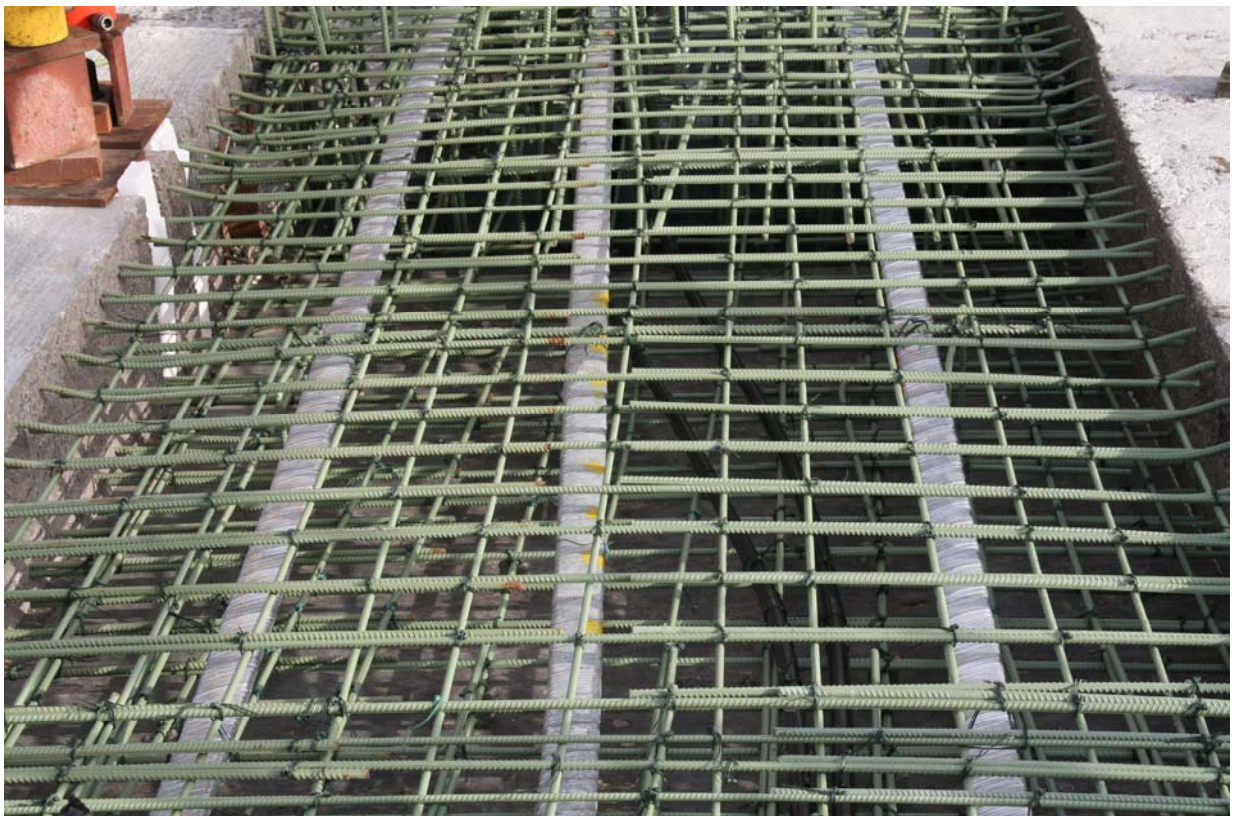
Mit Epoxydharz beschichtete Bewehrung (Foto: Horst Werkle)
